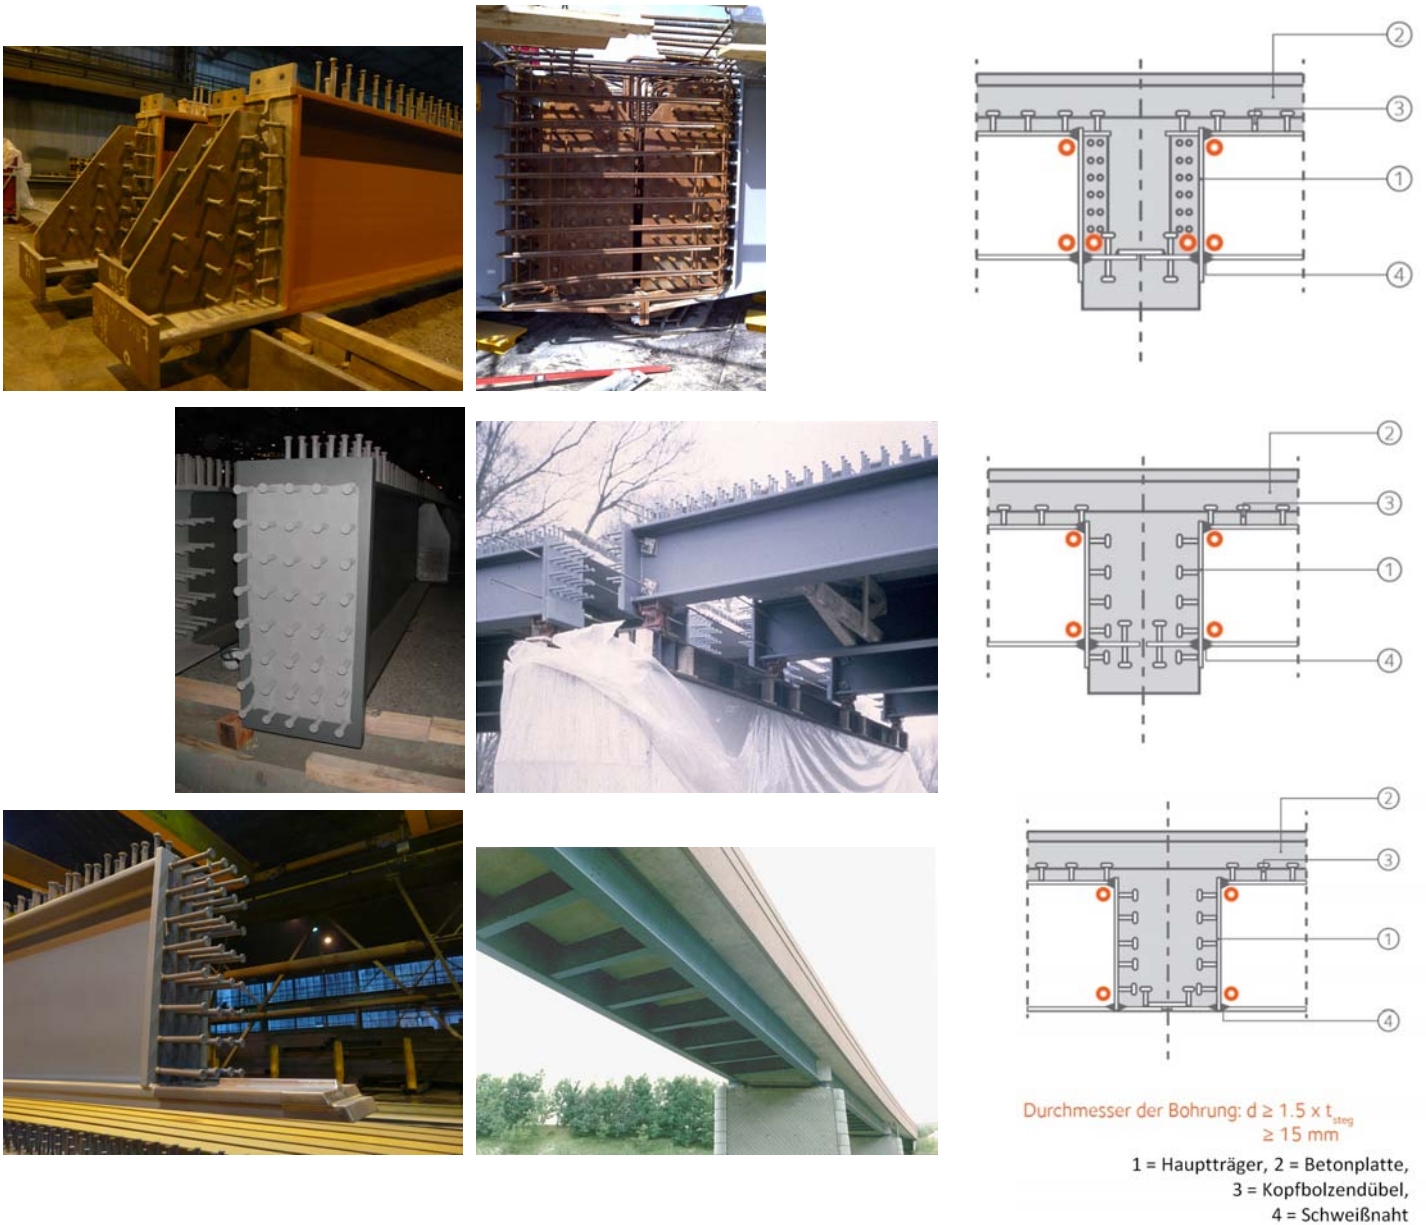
Detailausführung Betonquerträger als Mittelaufleger; links und mitte: Praxisbeispiele Fertigung, Montage, eingebauter Zustand; rechts: verzinkungsgerechte Ausführung mit Durchflussöffnungen
